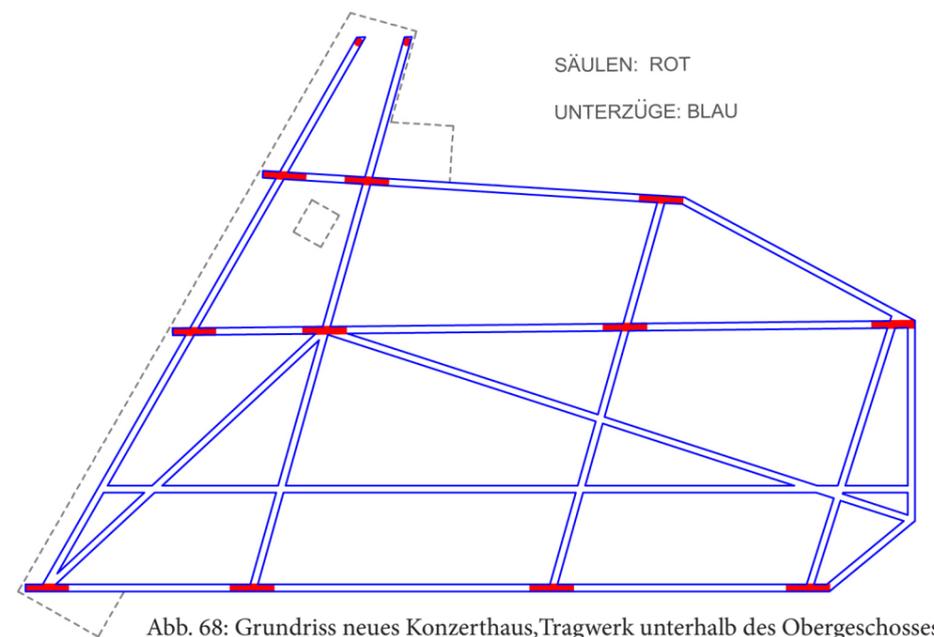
Grundriss neues Konzerthaus, Tragwerk unterhalb des Obergeschosses
